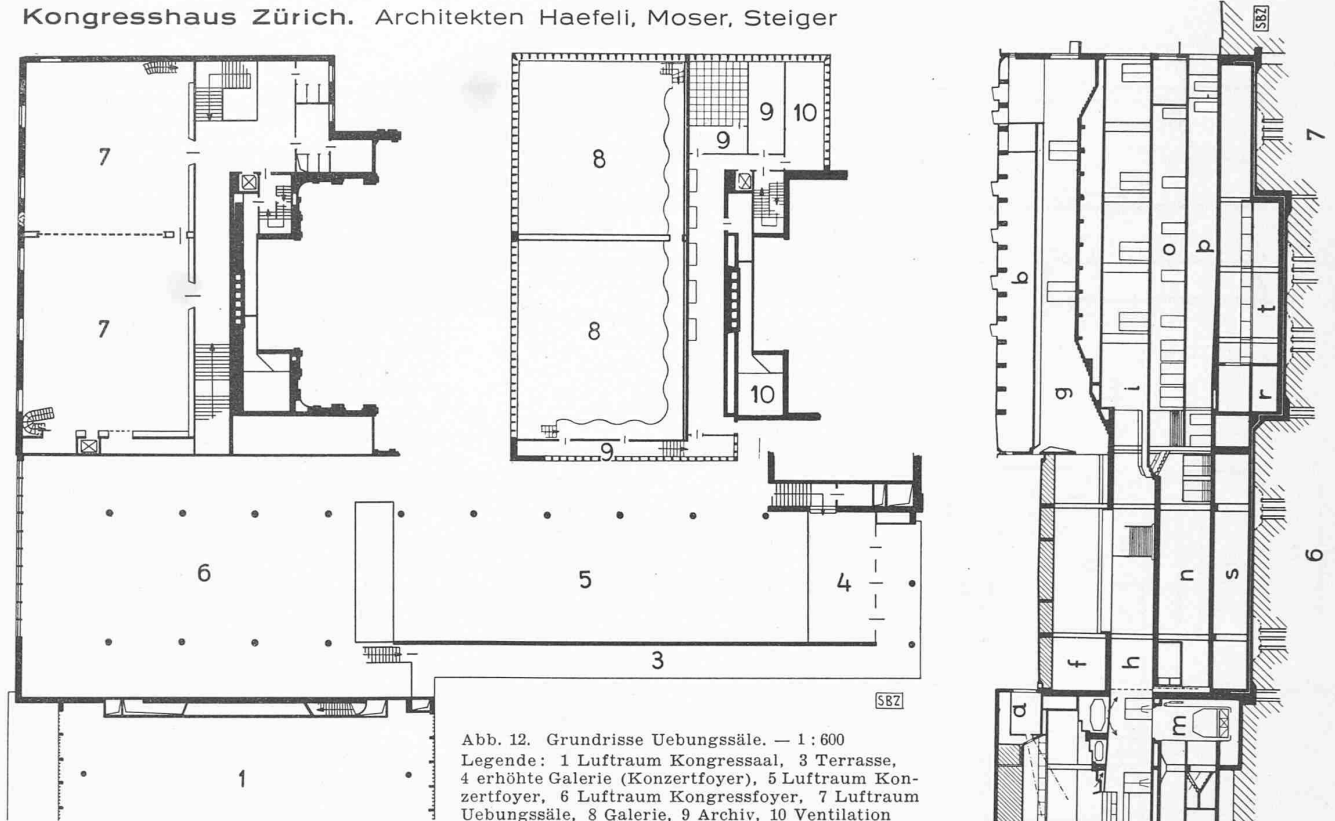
Grundrisse Übungssäle. — 1:600
